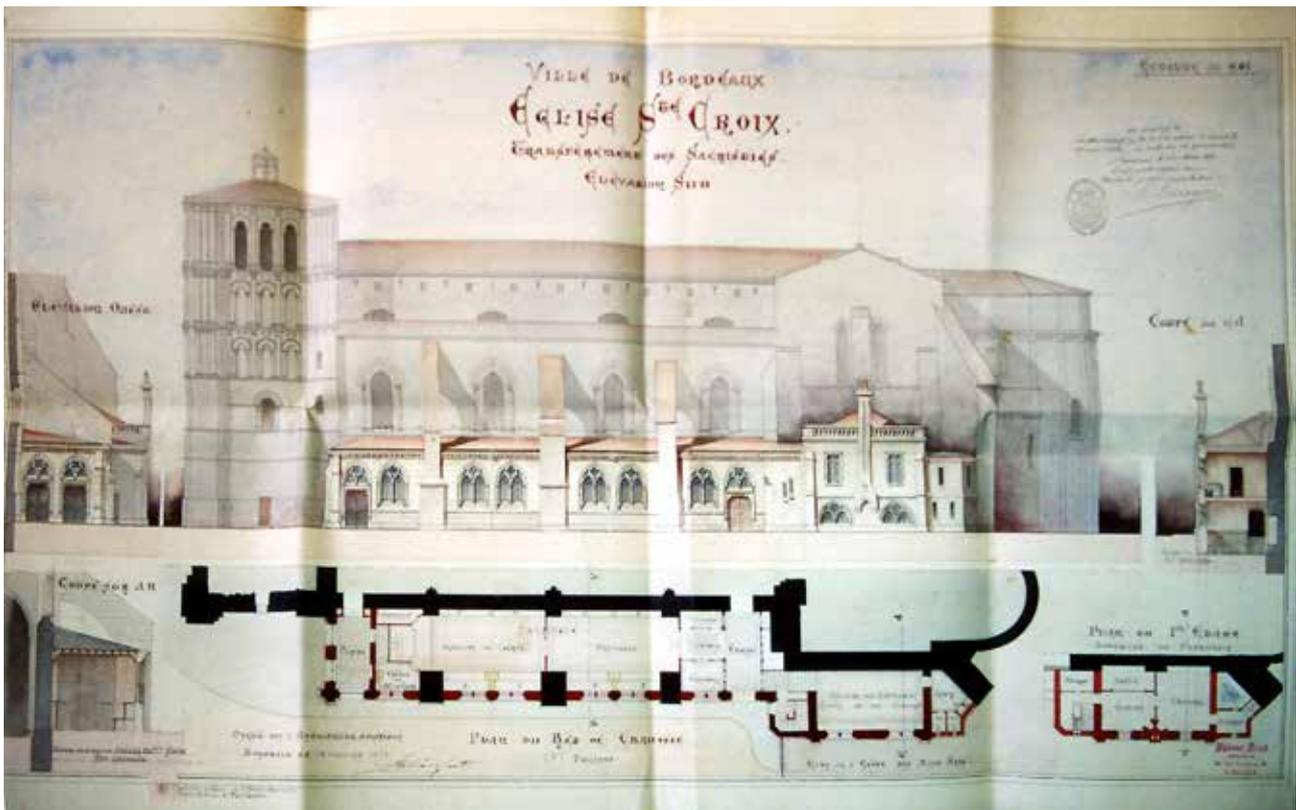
Projet de construction des sacristies par Alphonse Ricard du 14 janvier 1892 – Plan et élévation (A.M.Bx.).
